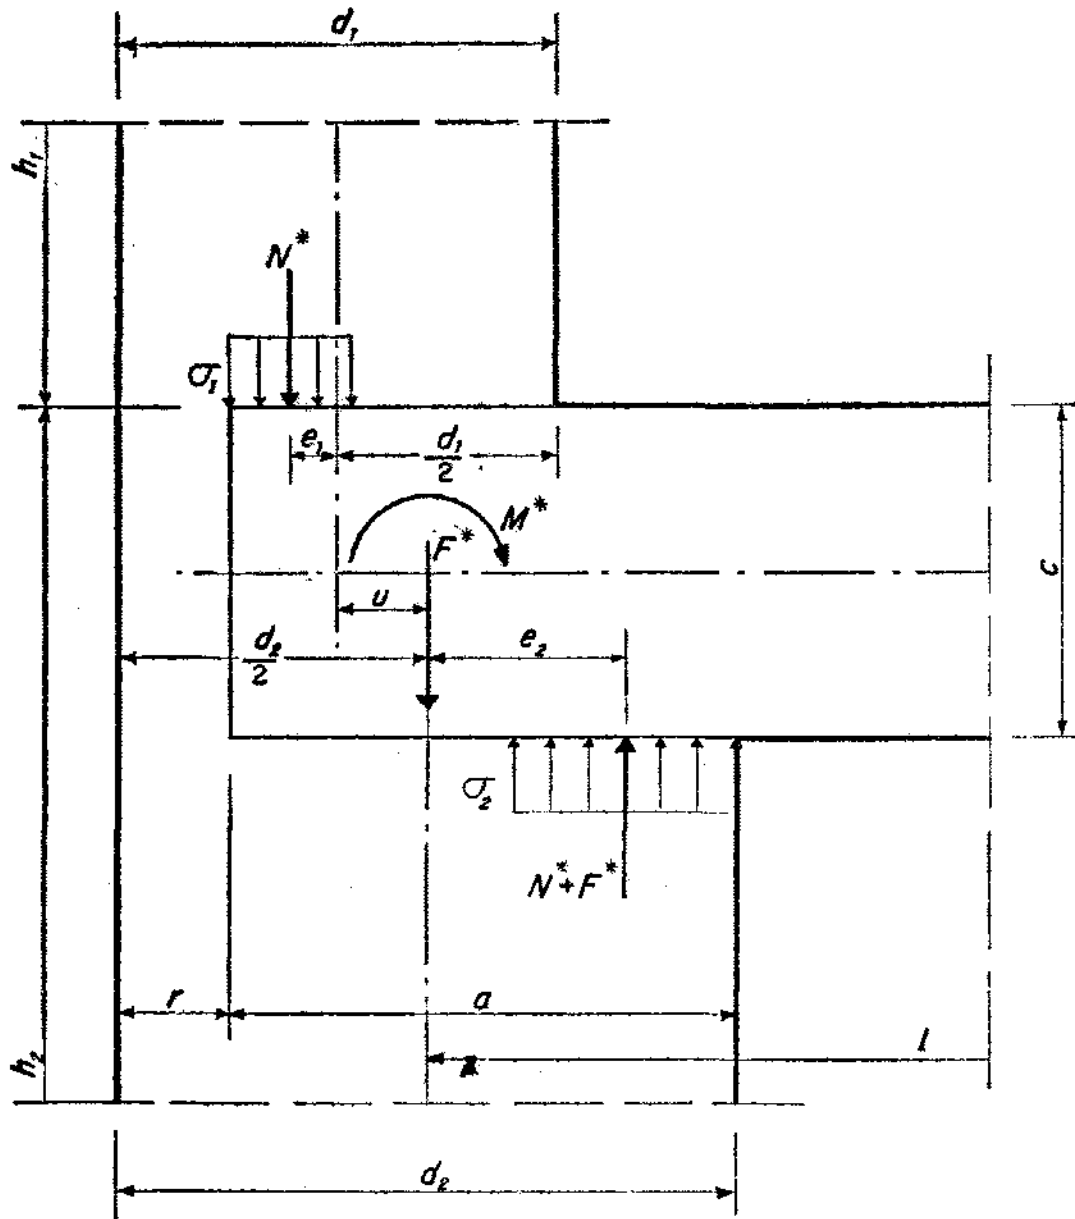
Cargas y tensiones en el empotramiento de un forjado en un muro extremo
